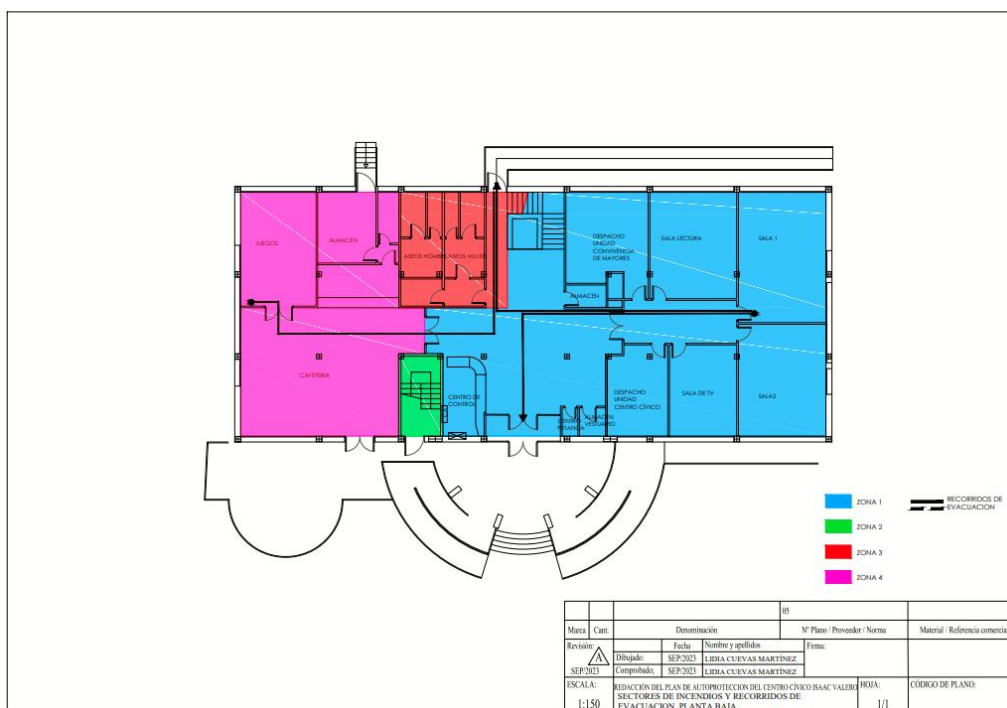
Plano dependencias y zonas planta baja. Fuente: Elaboración propia.
